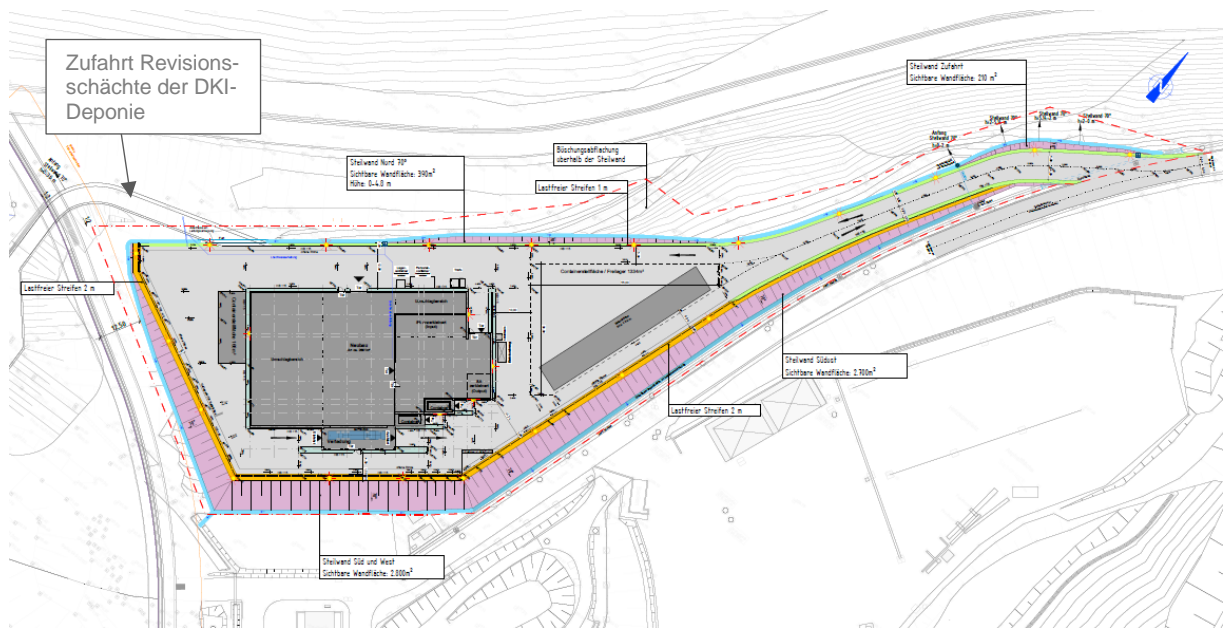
Ausschnitt Lageplan (SUT 2021)
